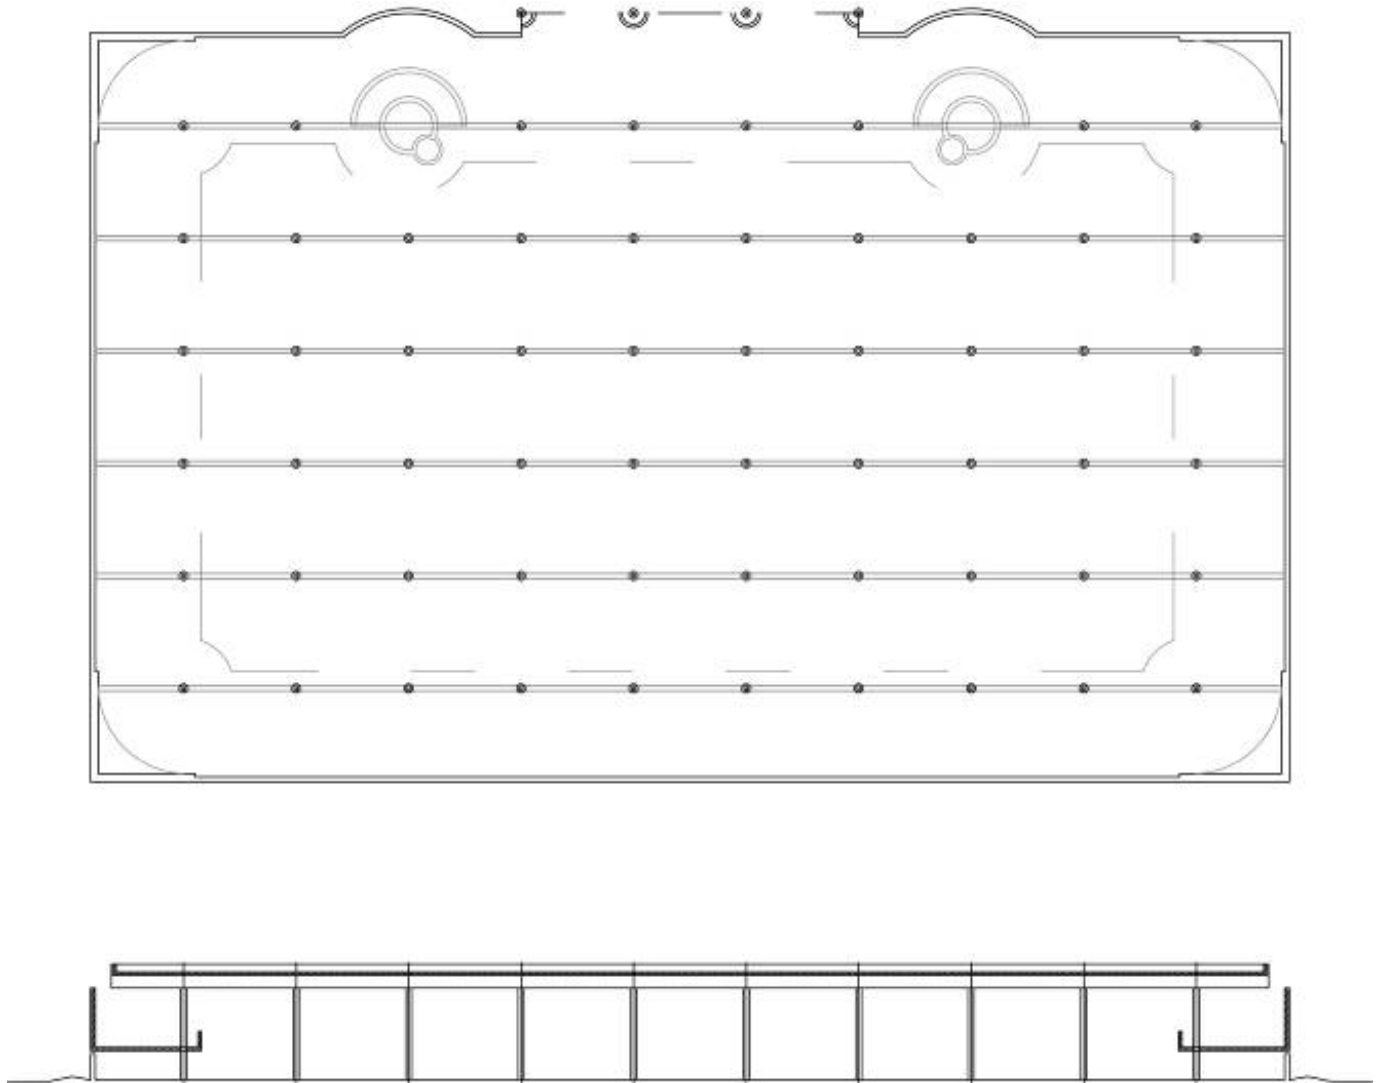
Propuesta con viga pasante y apoyos múltiples según distribución original.
